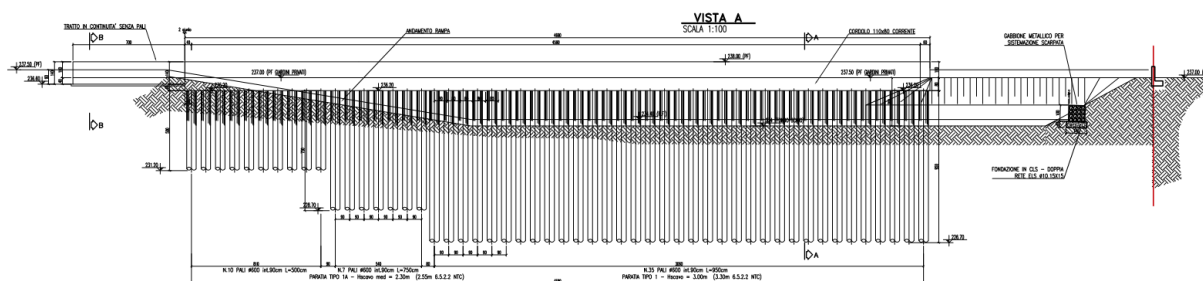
Prospetto paratia 1 (TRATTO 1)
